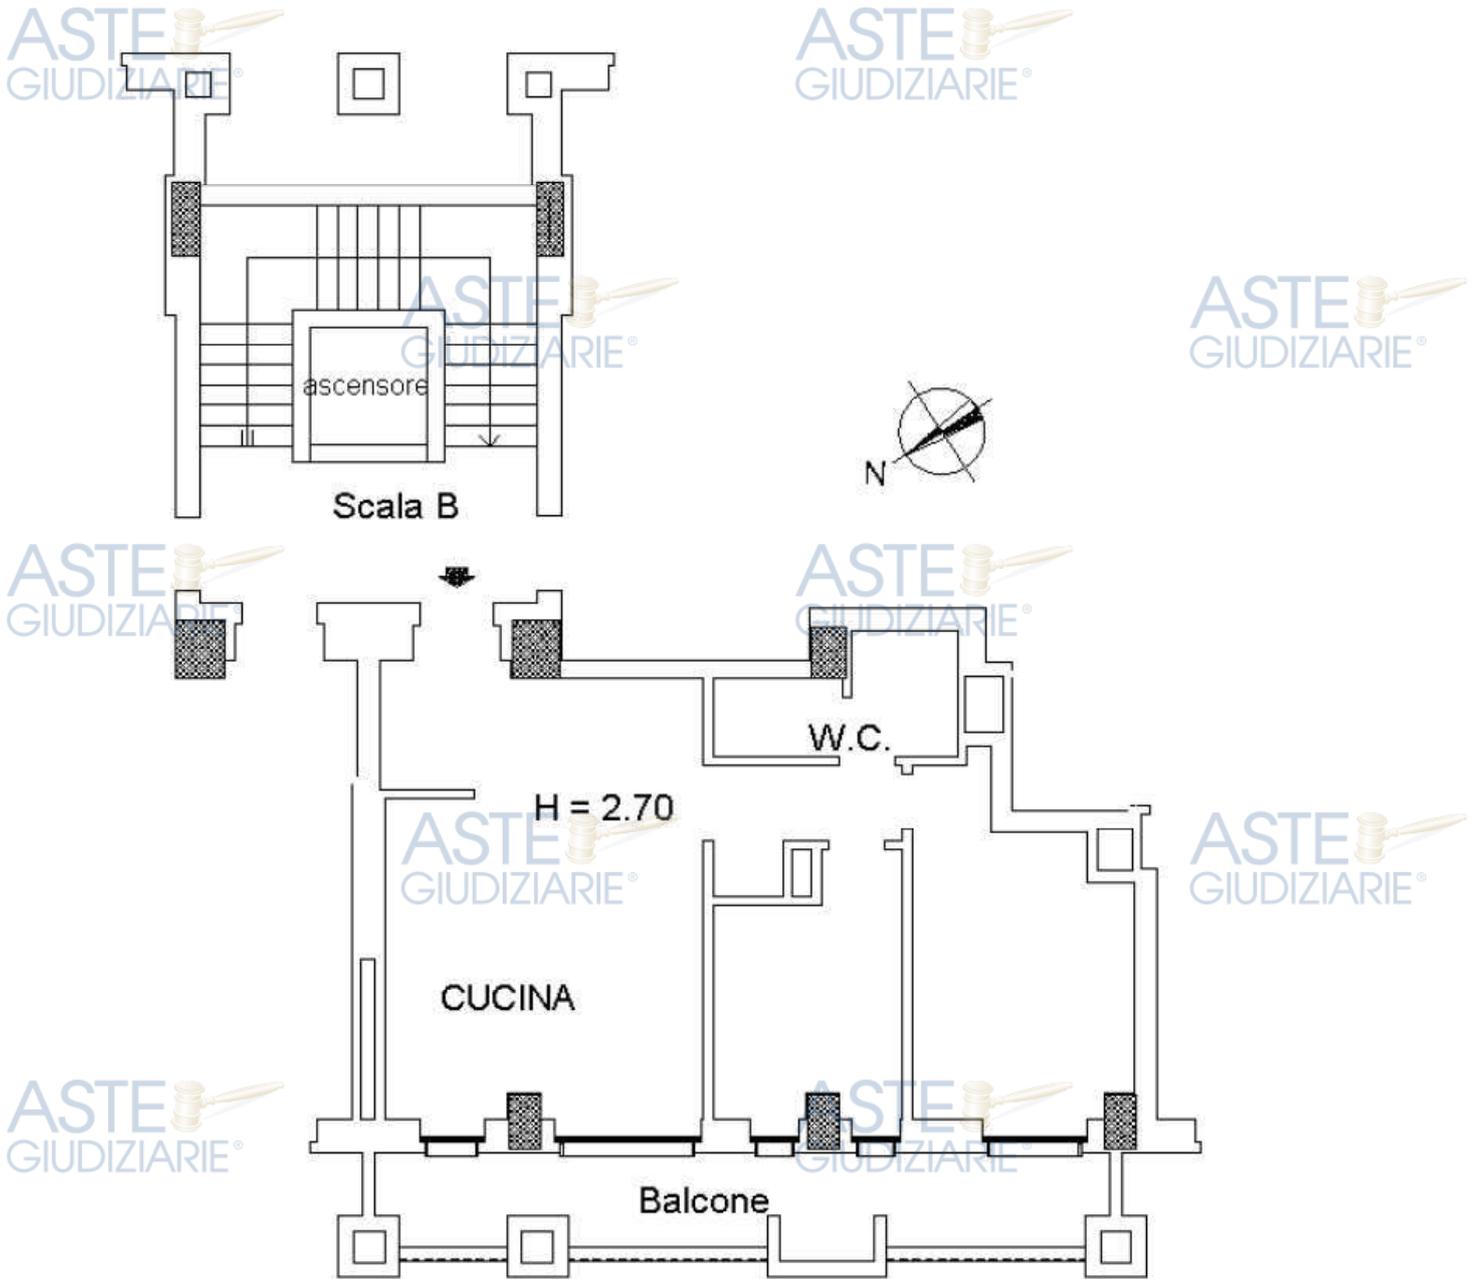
Planimetria presente al catasto urbano dell'abitazione.
